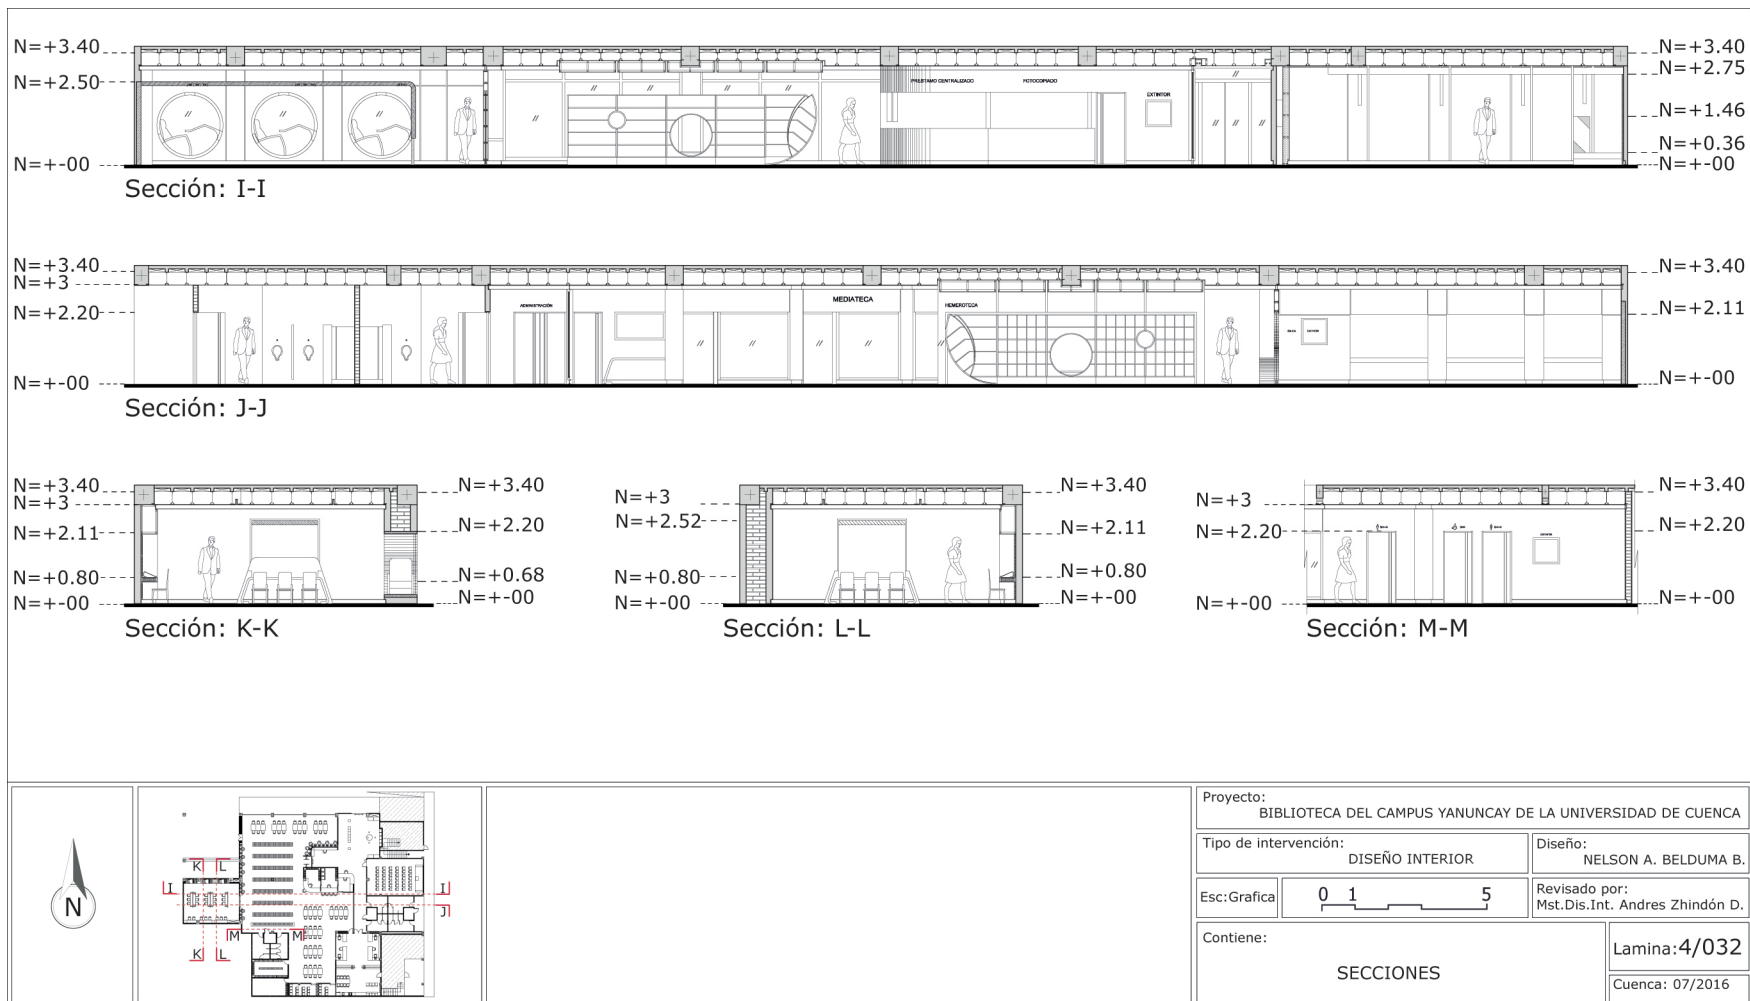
Sección I-I, Sección J-J, Sección K-K, Sección L-L, Sección M-M.
